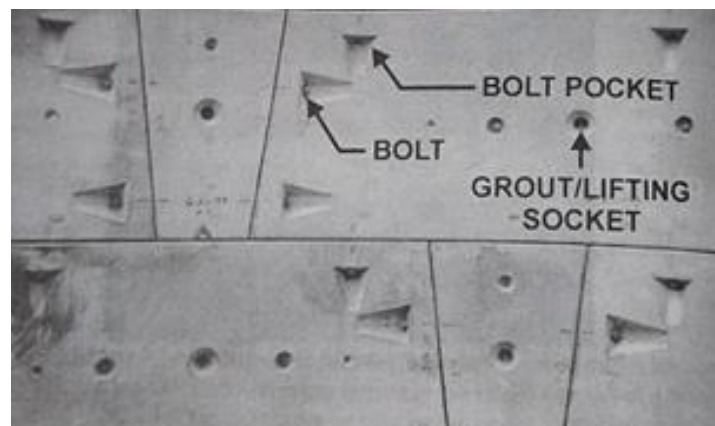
Detalhe de ponto de injeção do graute em anéis pré-fabricados de concreto (HENN, 2002)
